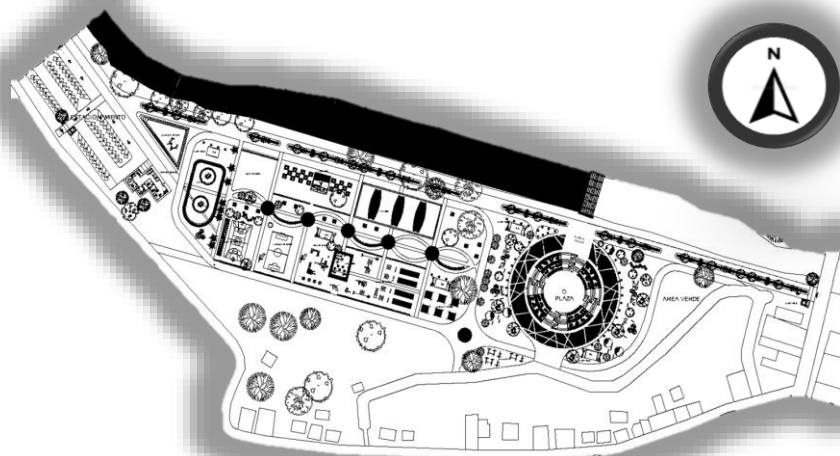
Planta de conjunto del parque lineal en Las Choapas, Veracruz.
